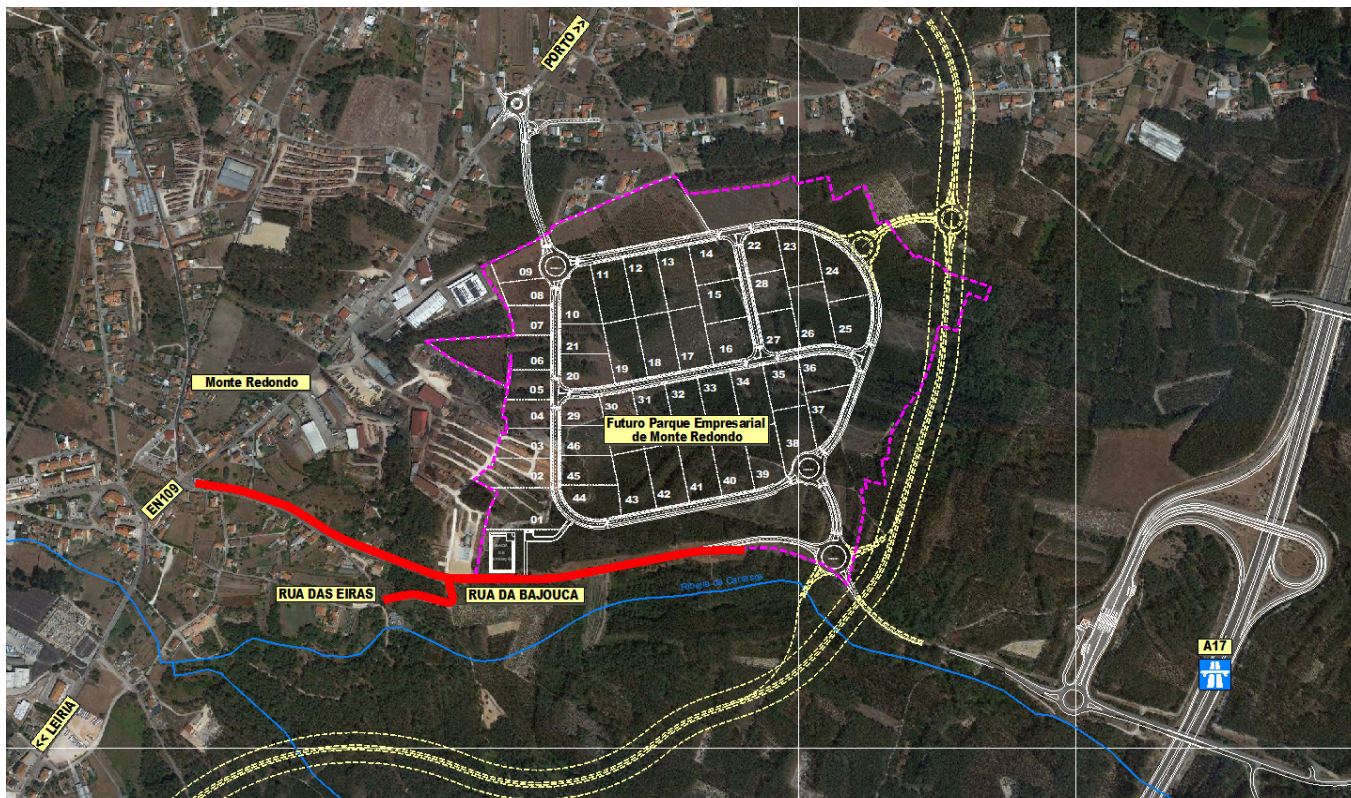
Planta de Localização da Intervenção (Fonte: Google Maps)
